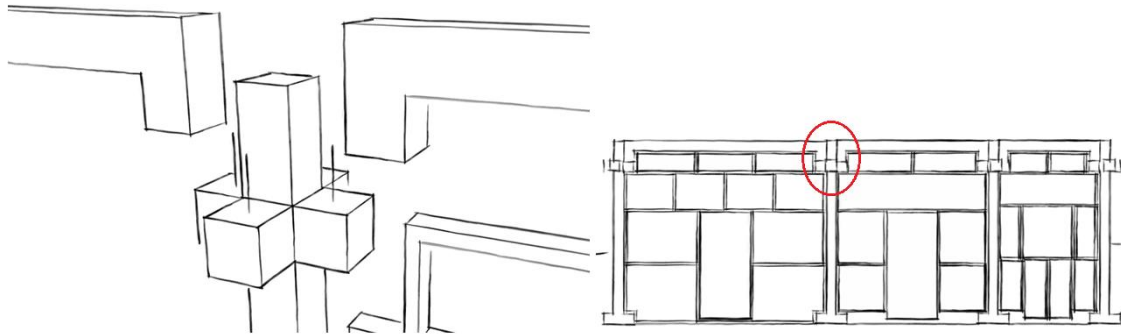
De Drie Hoven, Estrutura Pré-moldada.
